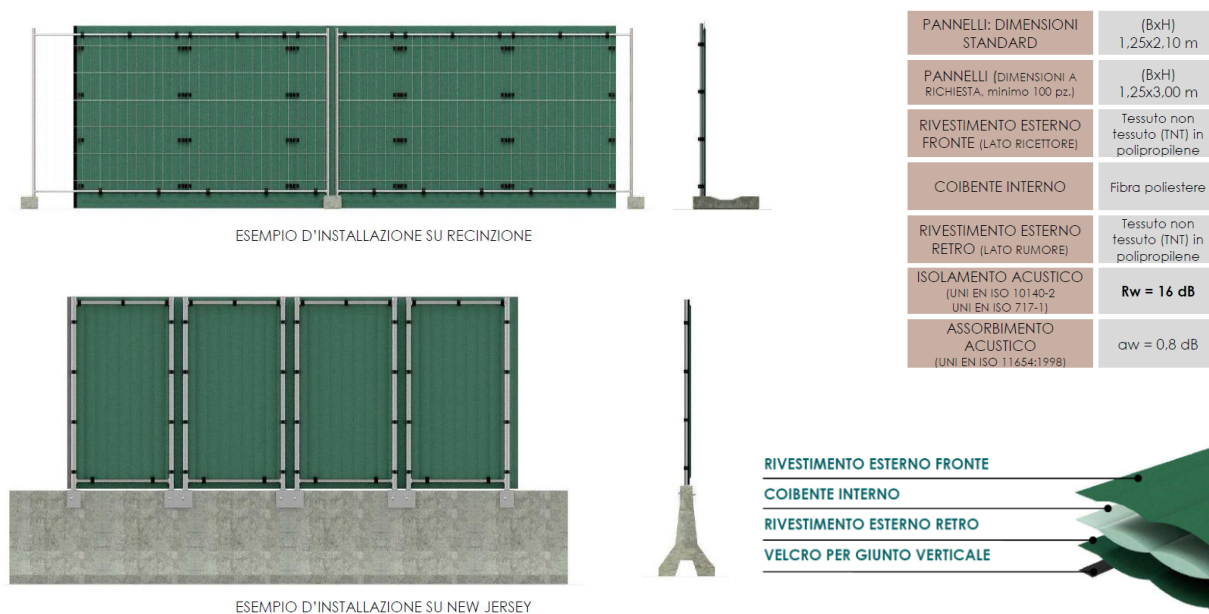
Esempio di pannello fonoassorbente da cantiere
